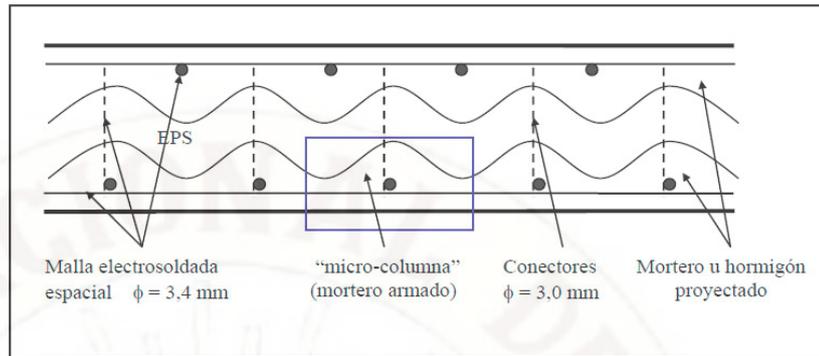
Vista en planta del panel tipo al finalizar su construcción
